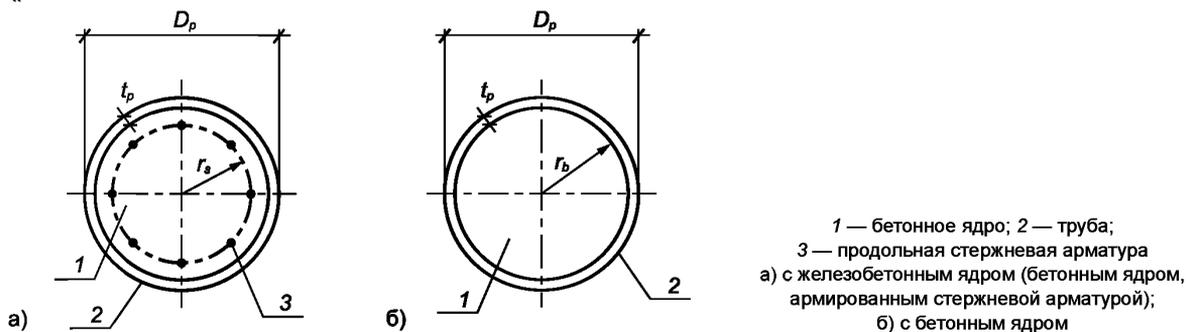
Типы сечений трубобетонных конструкций
